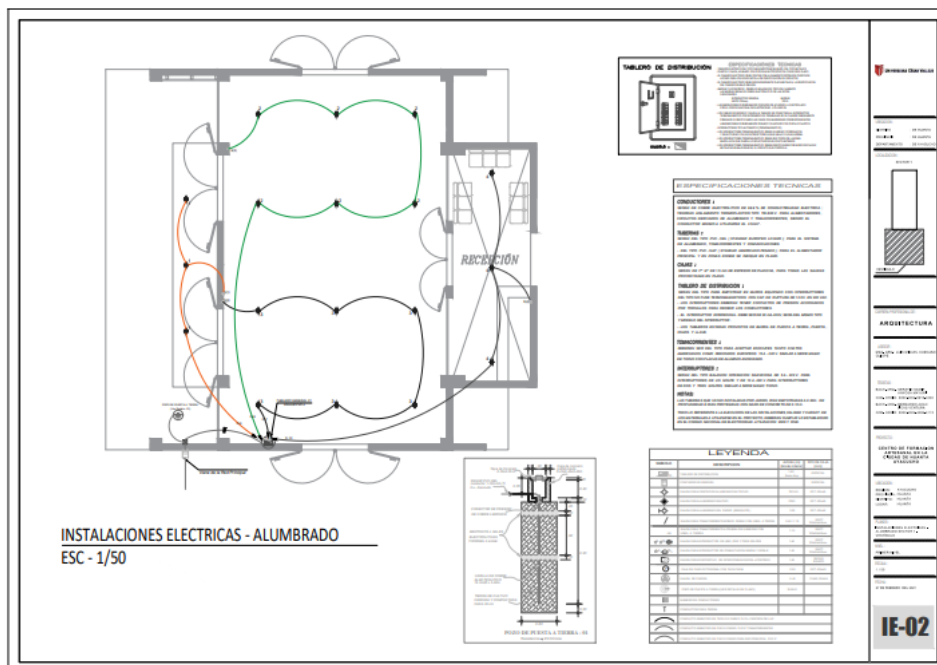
Plano de instalaciones eléctricas piso 2 - escala 1/50.
